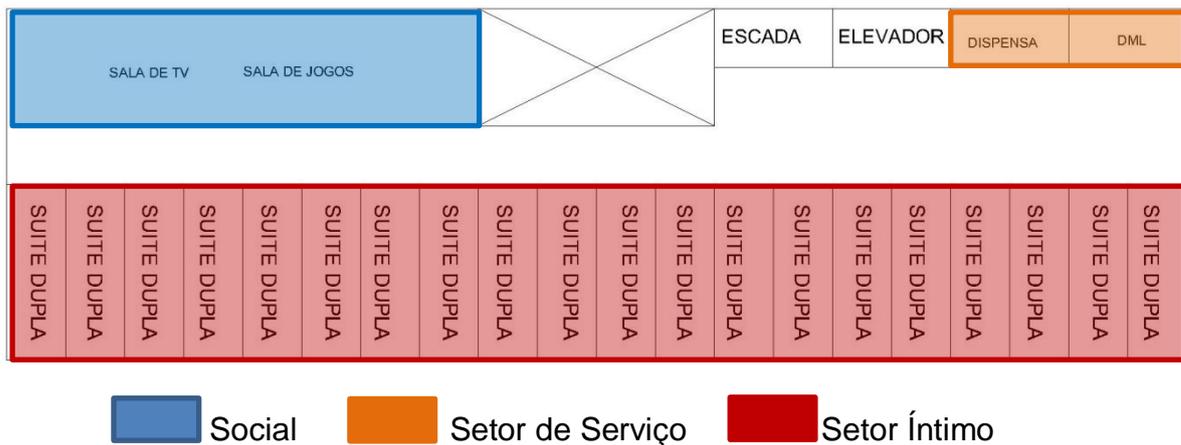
Bloco de hospedagem segundo pavimento setorizada - Disponível em: Fonte: elaborado pelo autor
